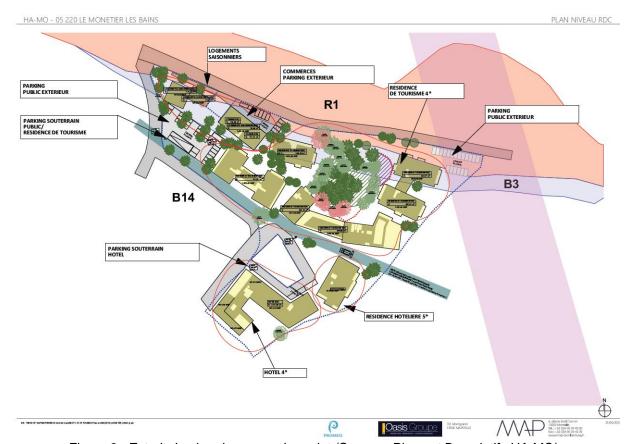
Extrait du plan de masse du projet (Source : Plans et Descriptifs HA MO)
